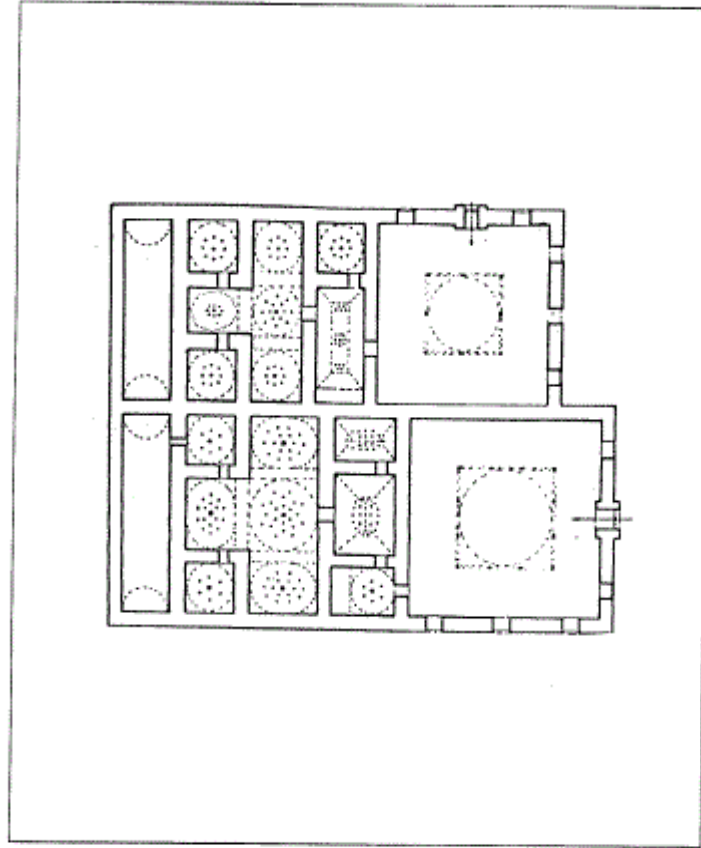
مكرر) مسقط أفقي لحمام خاصكى حرم بإستانبول (عن : جودوين)
